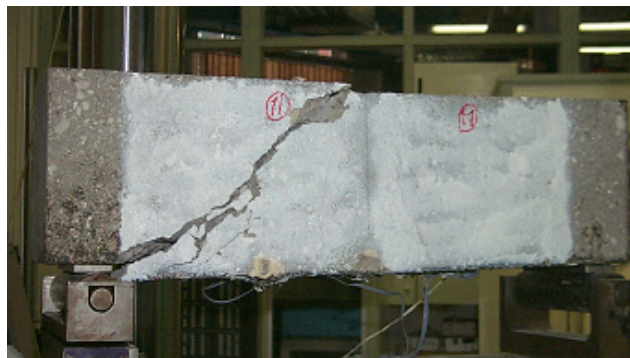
Rupture d'une poutre renforcée en mode a
